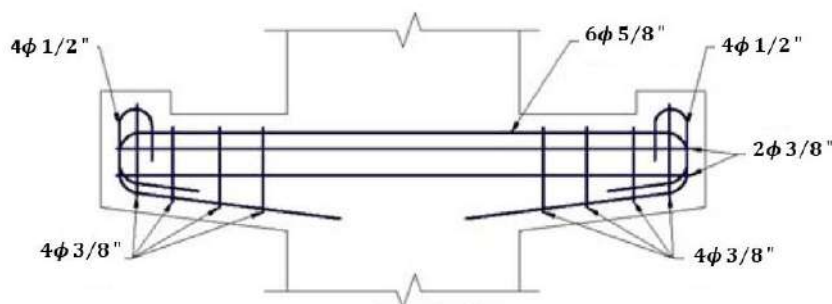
Armado de refuerzo de las ménsulas para las vigas JT55.
